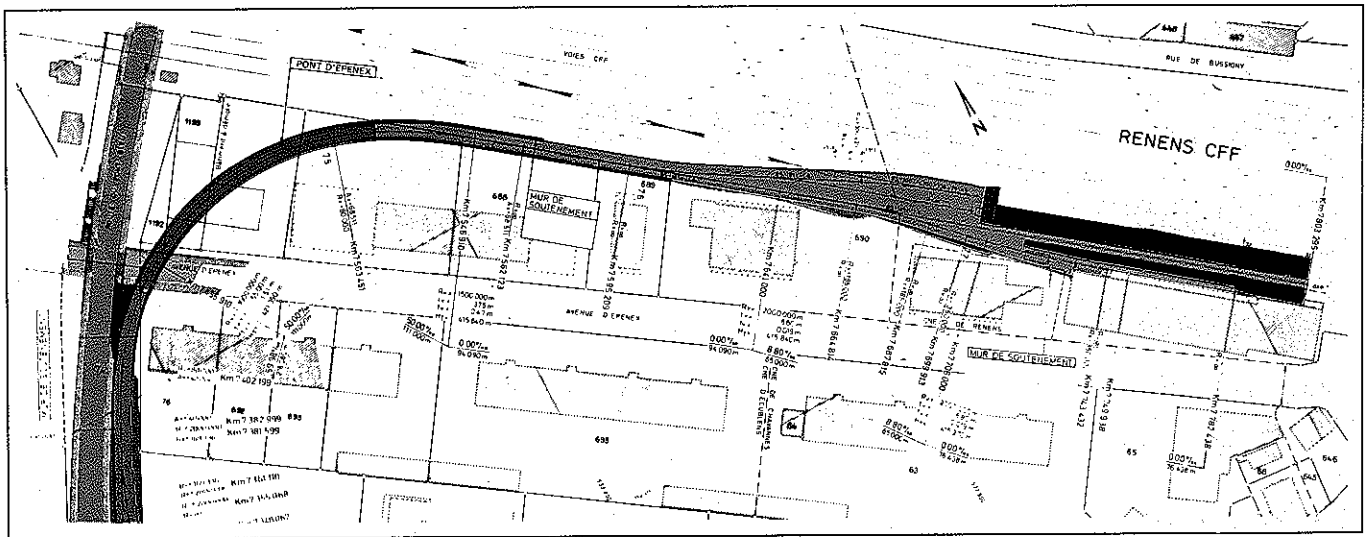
Secteur Epenex–Renens CFF: plan de situation.
